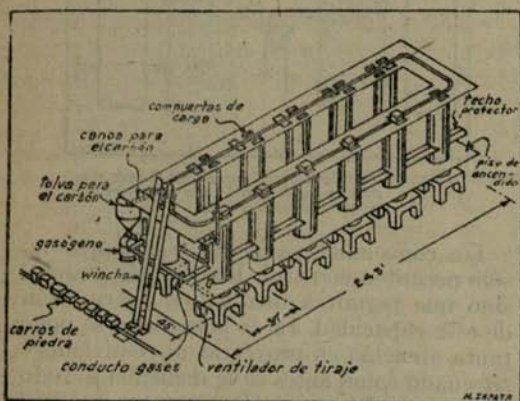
Vista isométrica de una planta para 1000 toneladas de cal.
